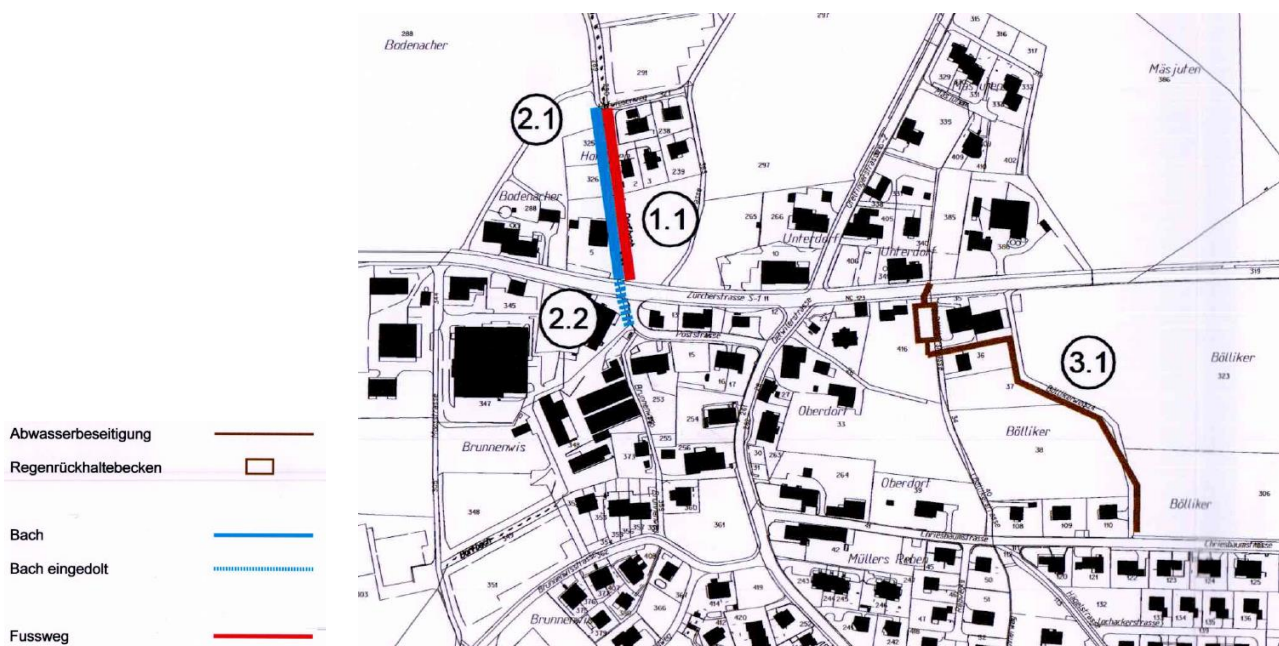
Ausschnitt Erschliessungsplan Hüttikon
